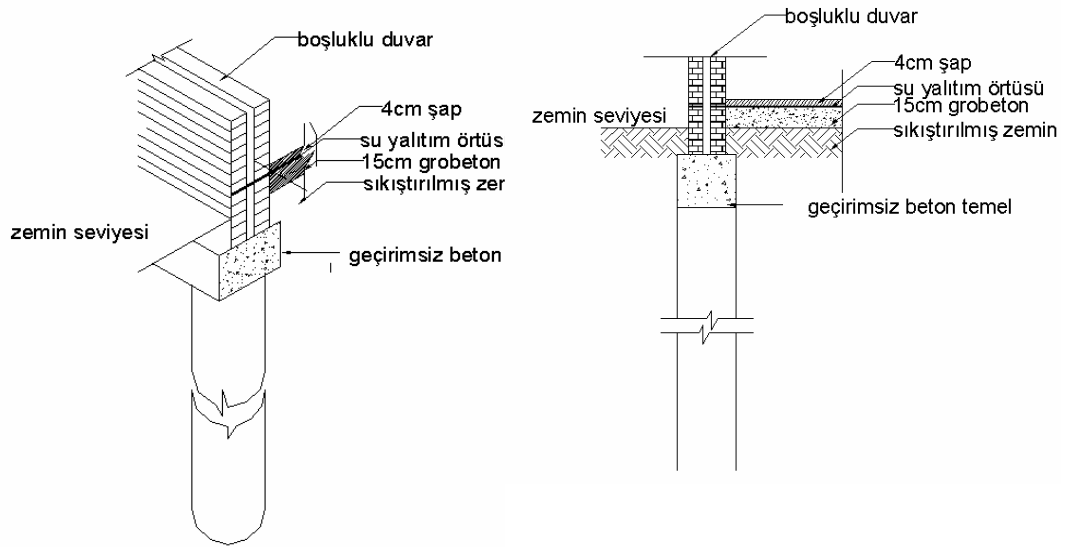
'daki bu tür kazık sistemlerde kum veya prefabrik betonarme, çelik, ahşap, mix. vb. malzemeler kullanılır.
